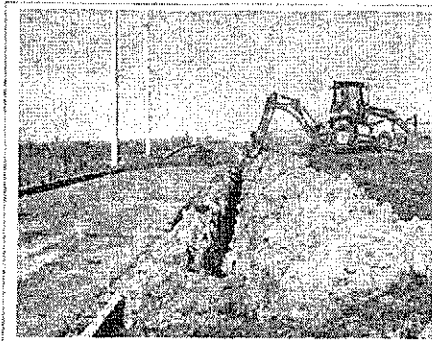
Pavimentação e Escavação mecanizada para Rede de Distribuição de água
